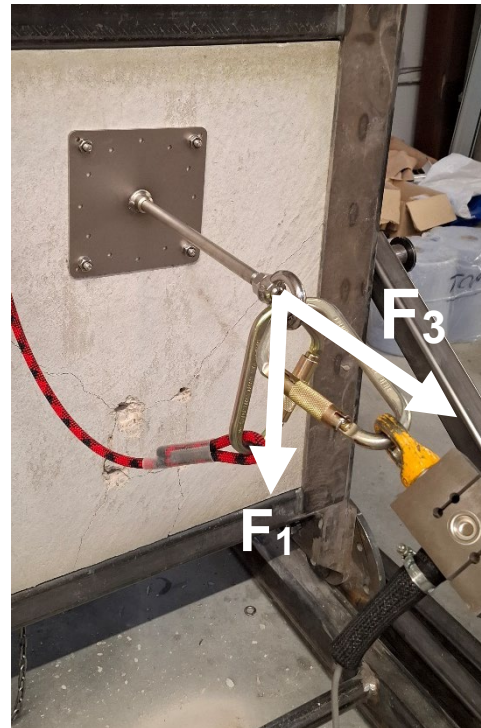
Prüfaufbau 2, Anschlagereinrichtung,
